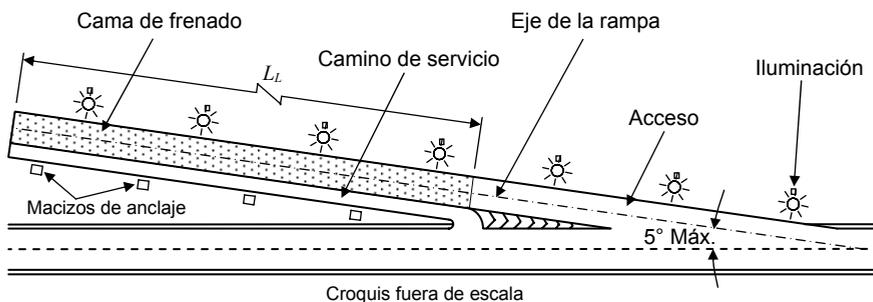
Rampa para frenado de emergencia. Disposición en planta
